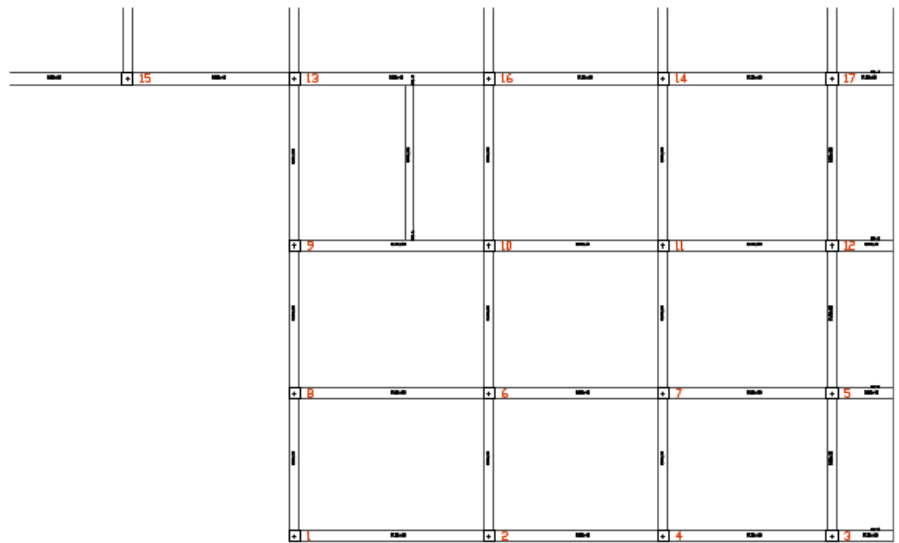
Detalle de viga de hormigón armado del Nivel 1. Producido en ANGLE y AutoCAD.
